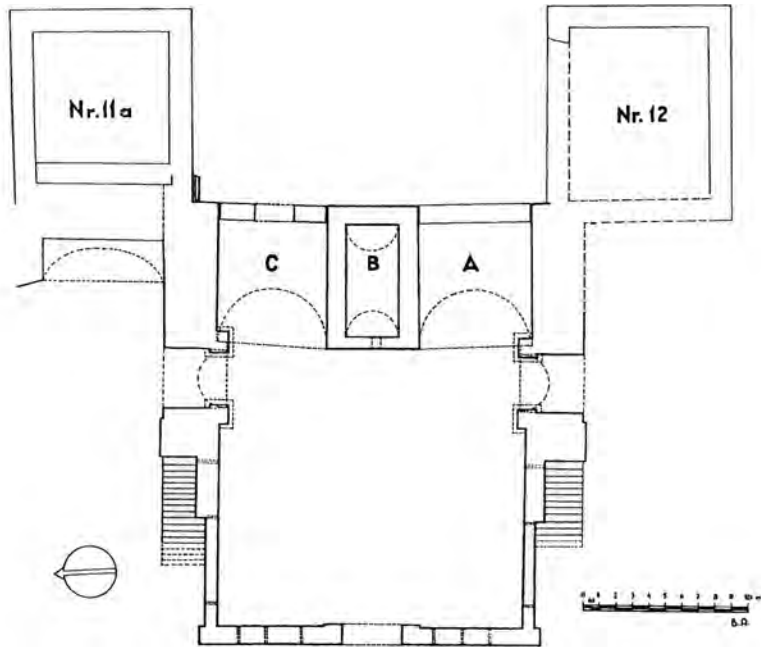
Hellenistische Stadtmauer, O-Tor, Grundriss
